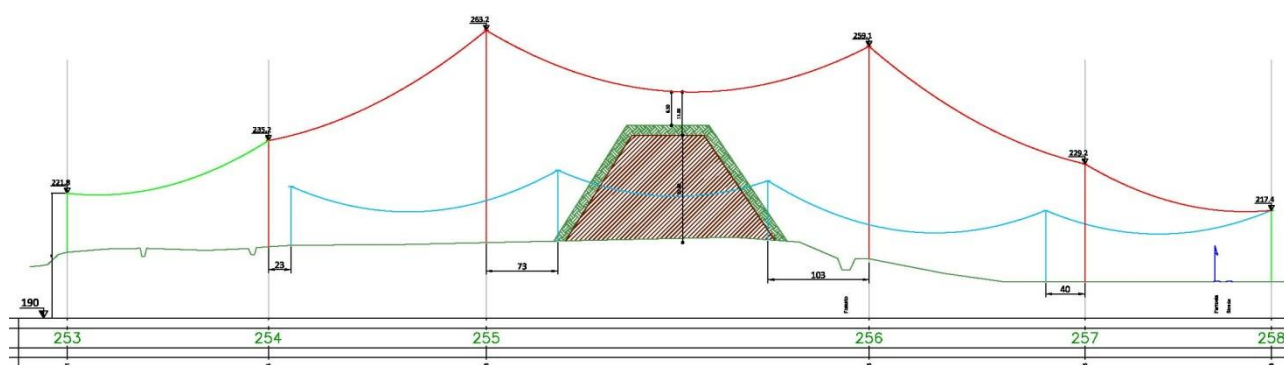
Profilo schematico della sopraelevazione della linea elettrica.
